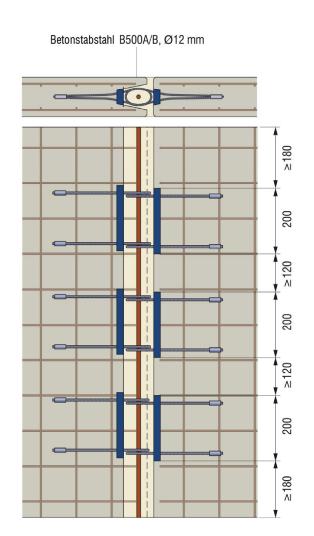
Geometrie, Bewehrung (Detail Fertigteil A und B)
